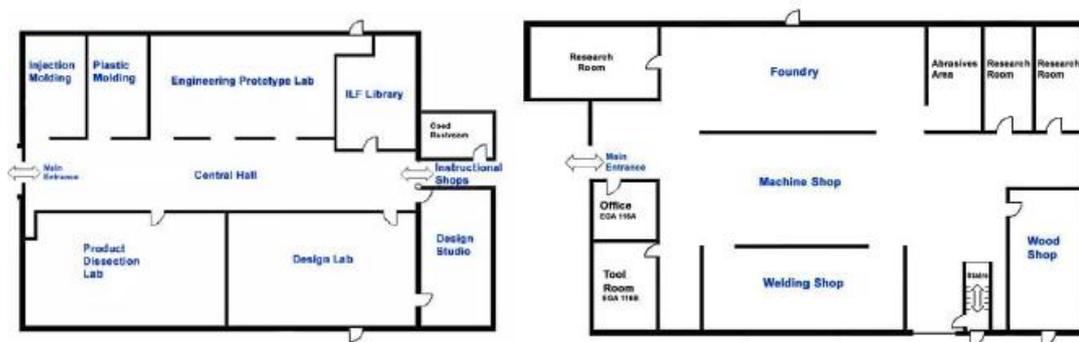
Plano de Learning Factory de la Universidad de Washington (H. Hadlock, 2008)
